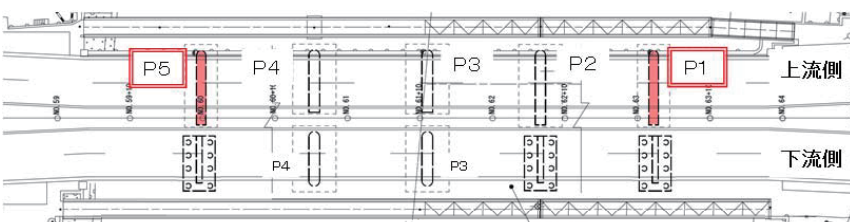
全体一般図(平面図) ■ :アラミドFRPロッドによる耐震補強施工箇所
